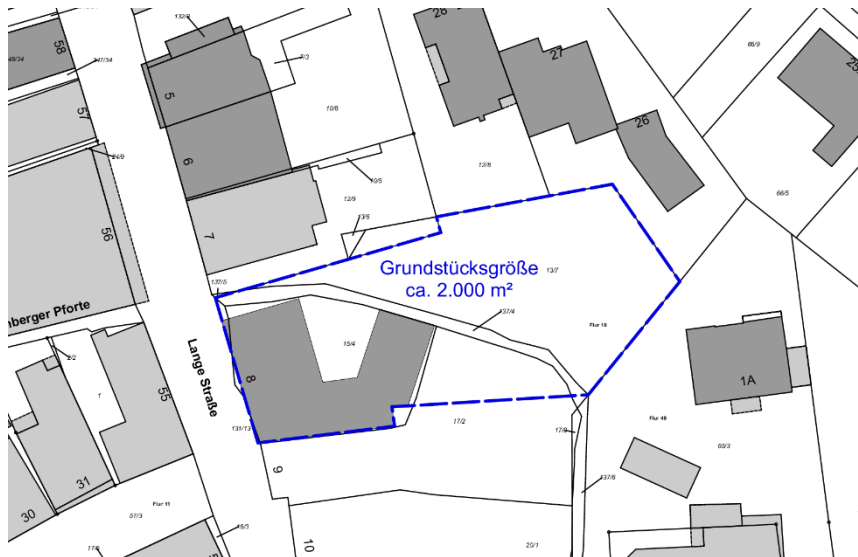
Grundstück inkl. des optional zu erhaltenden Gebäudes Lange Straße 8 (Kartengrundlage: Stadt Diepholz)
